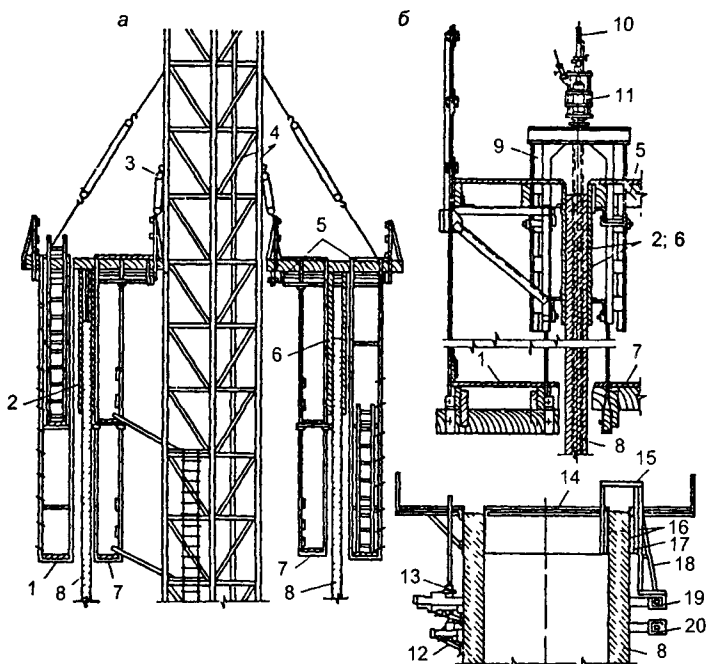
Бетонирование стен ствола водонапорной башни:
